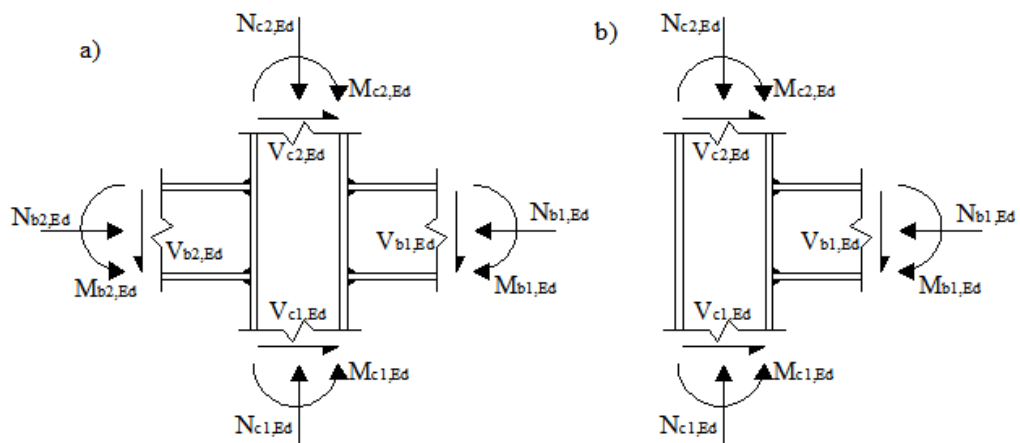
Esforços nas ligações viga-pilar com pilar interno (a) e de extremidade (b).
